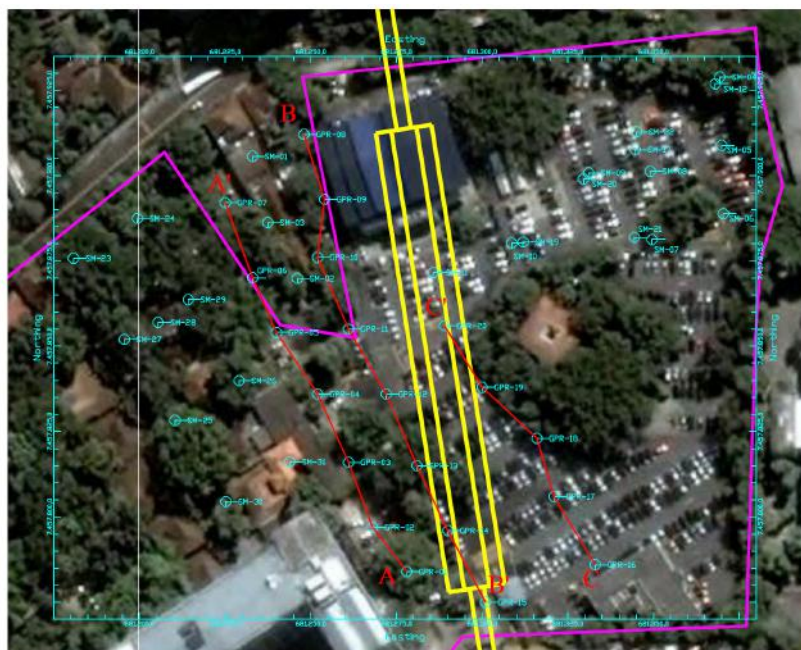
Planta de situação das sondagens e do levantamento geofísico
